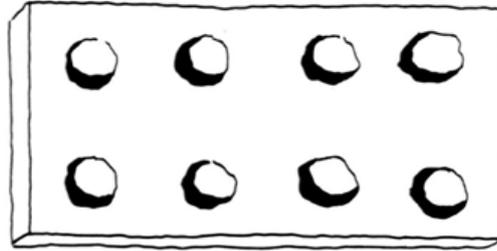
Fixação por colagem parcial por pontos [4]
